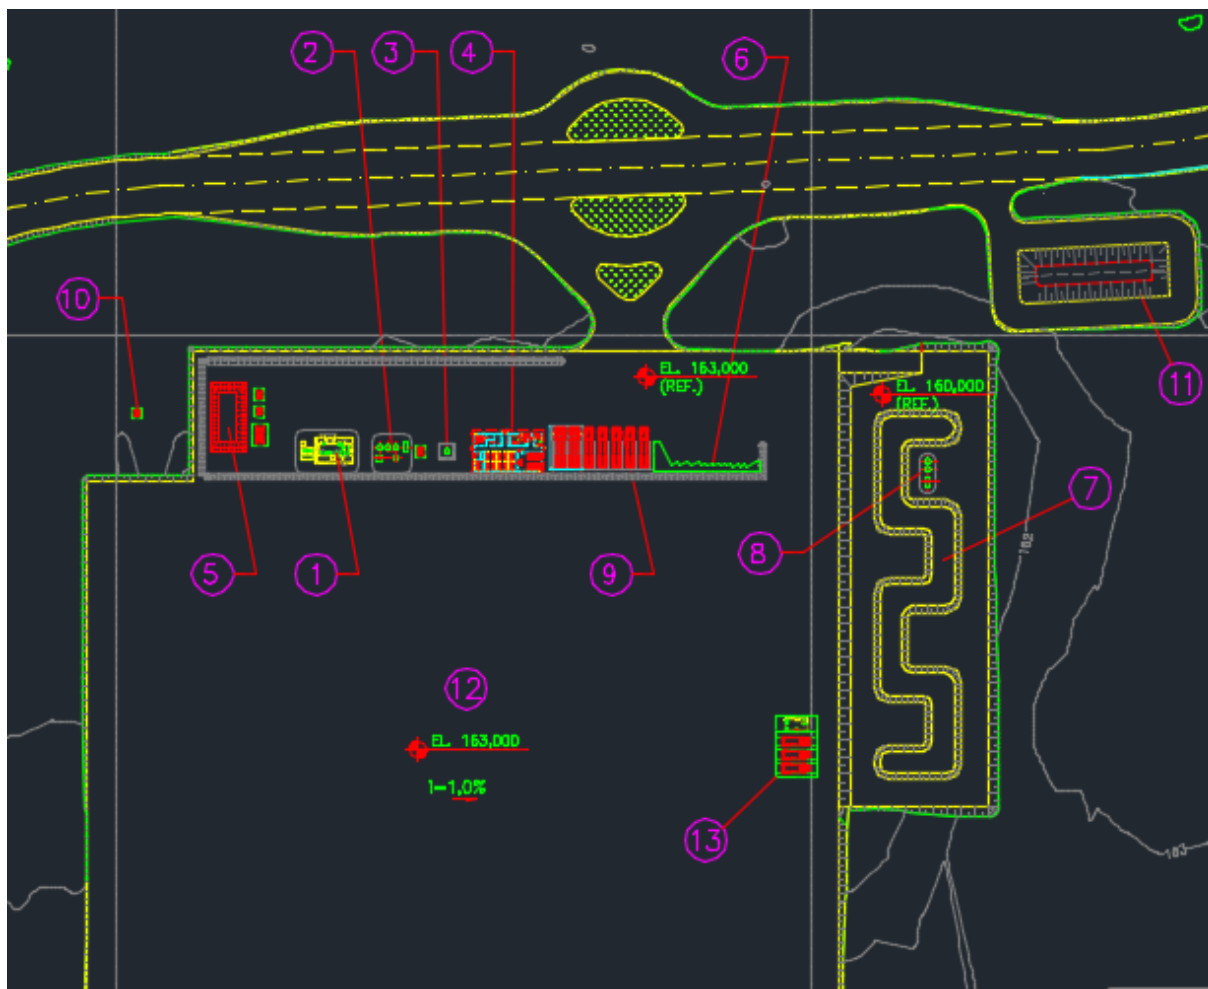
Layout das instalações provisórias na área Monte Branco Oeste.
